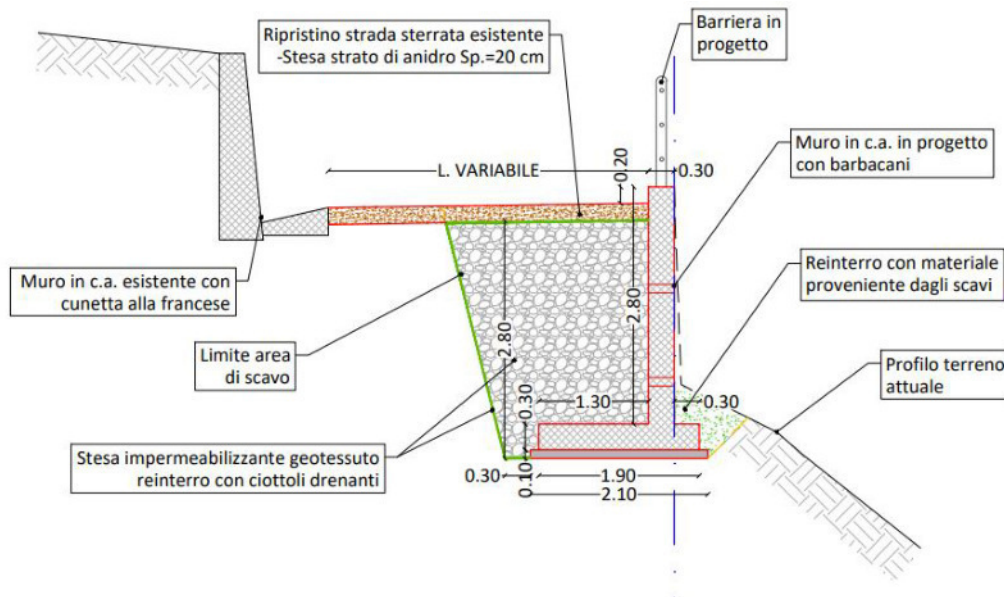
Sezione tipo muro in c.a. – intervento 11.
